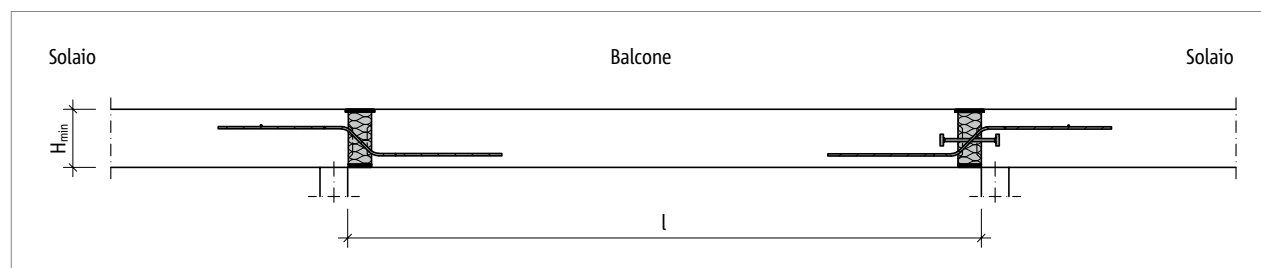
Schöck Isokorb® T tipo QP-Z, QP: sistema statico
